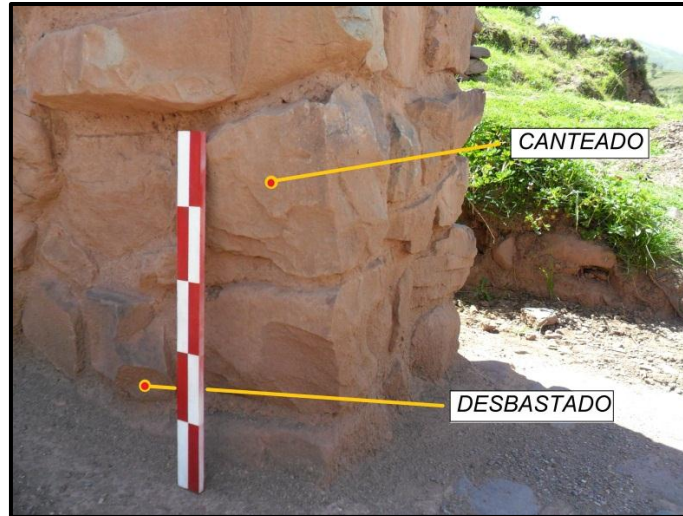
Nivel de trabajo desbastado así como canteado aplicado a los elementos líticos. (Fuente Propia)
